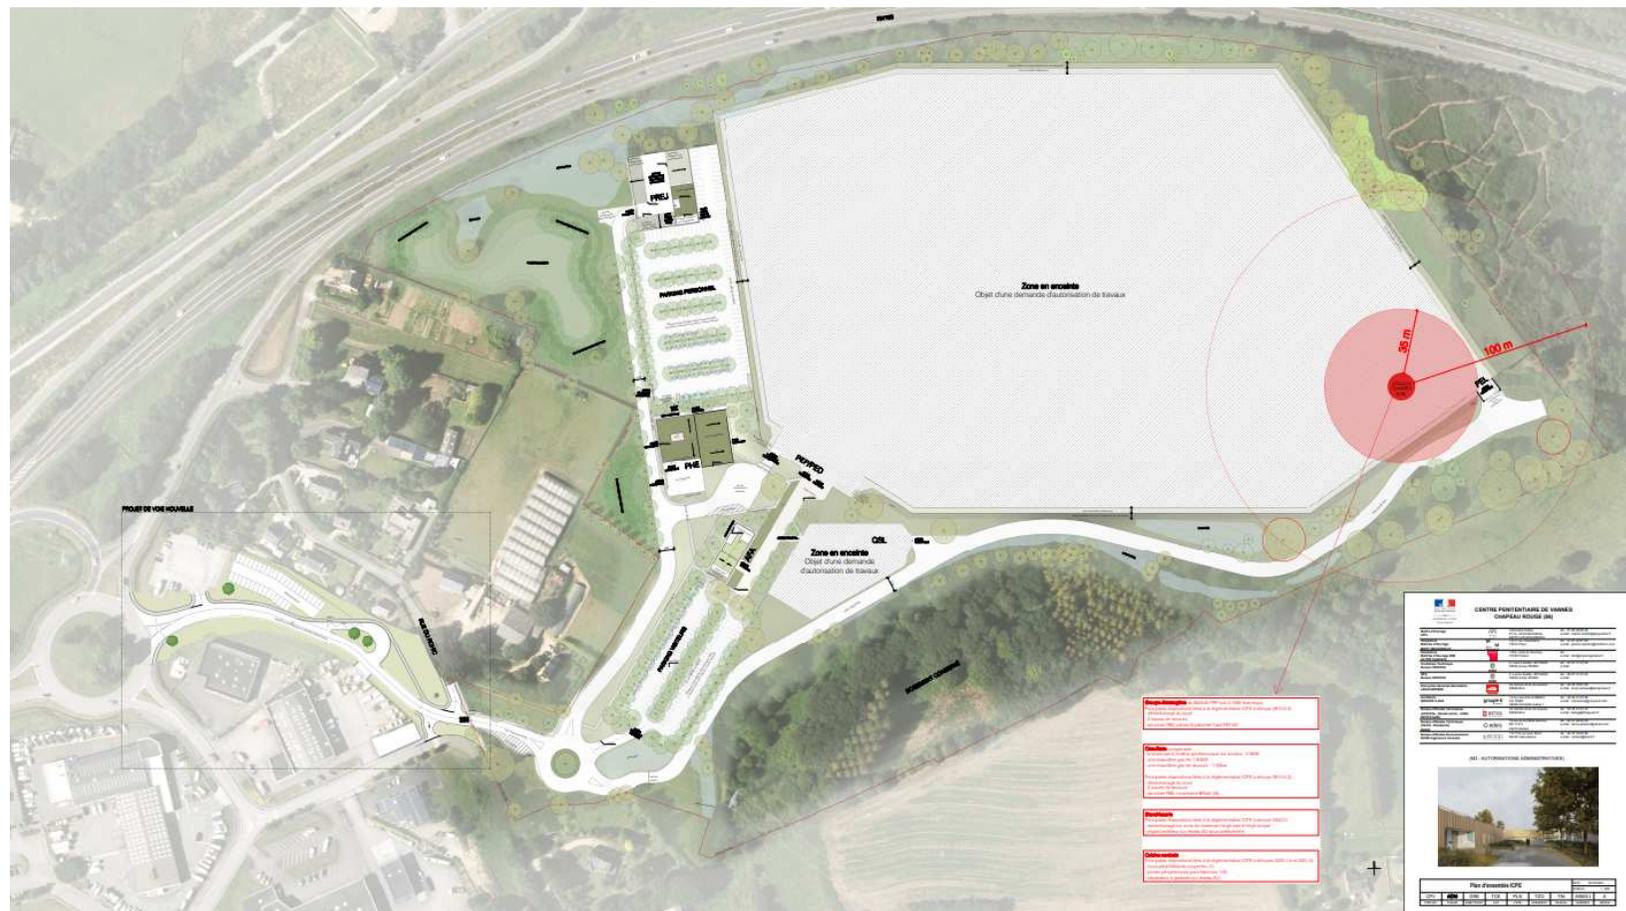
Situation des ICPE sur le plan masse (Source : GROUPE 6 Architectes)
